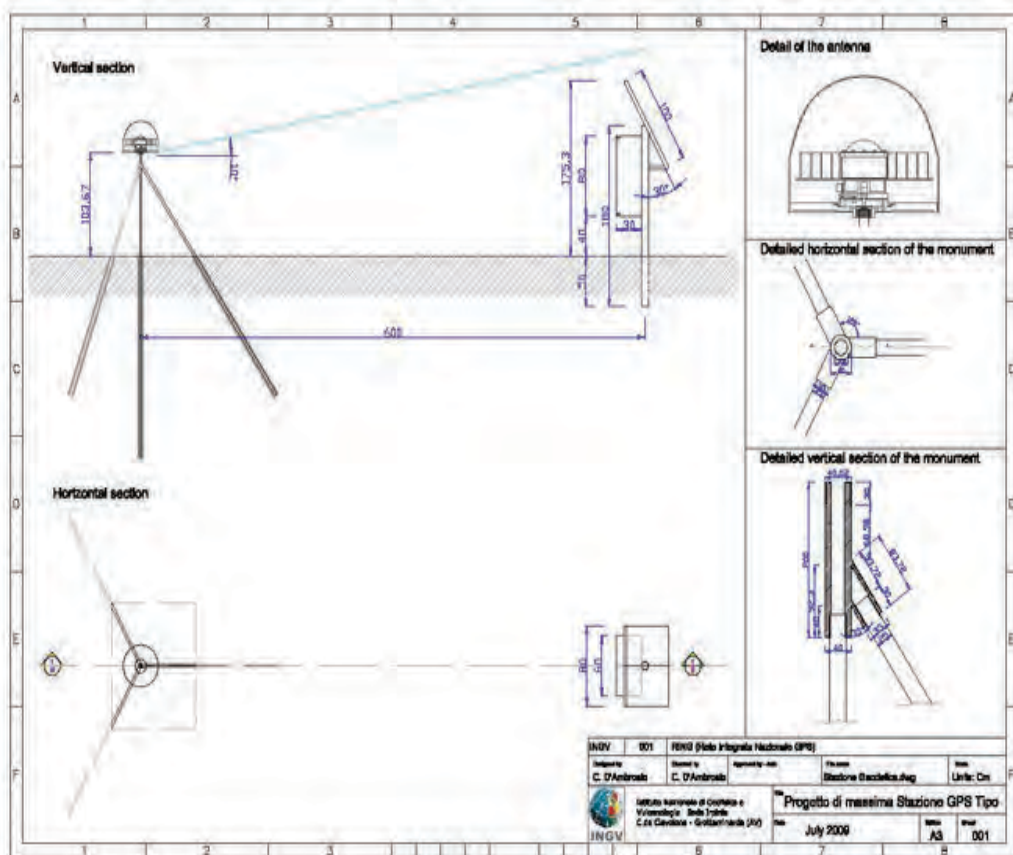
Pianta della stazione geodetica tipo installata nel Pollino - scala 1:50.
